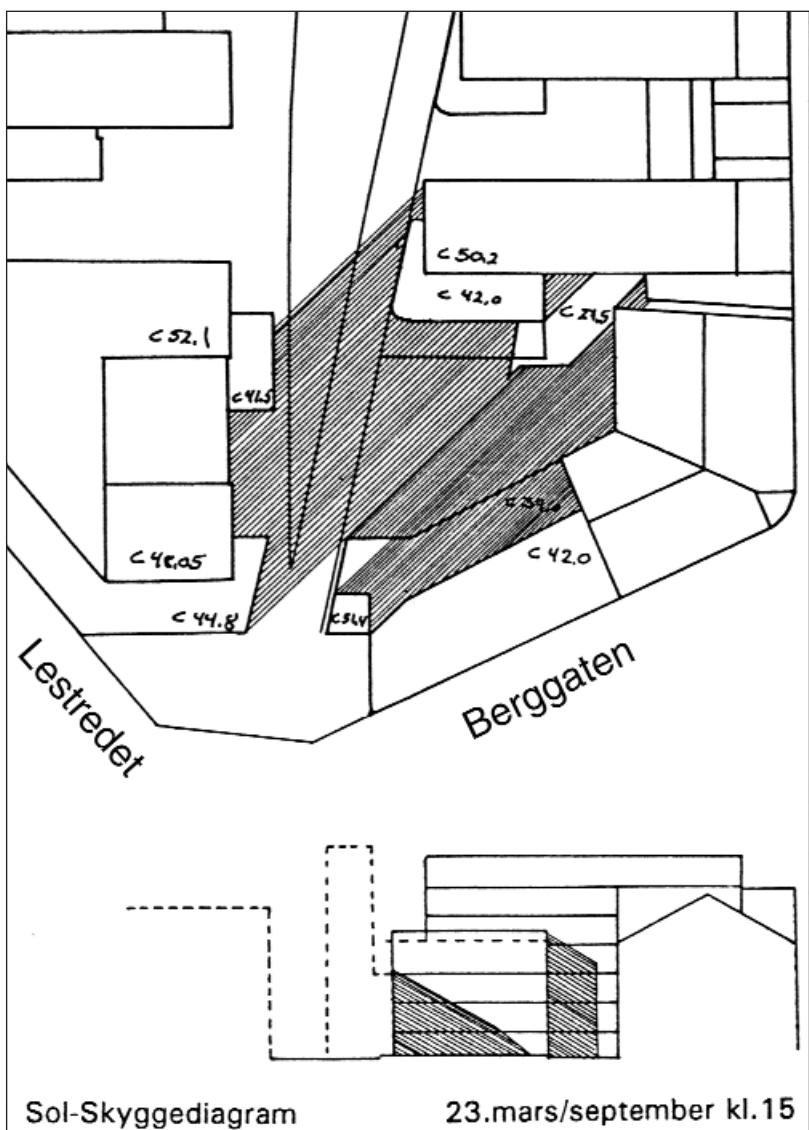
Illustrasjon til utbyggingsplan Eksist. bygg Eksist. mur/fasade Nybygg
